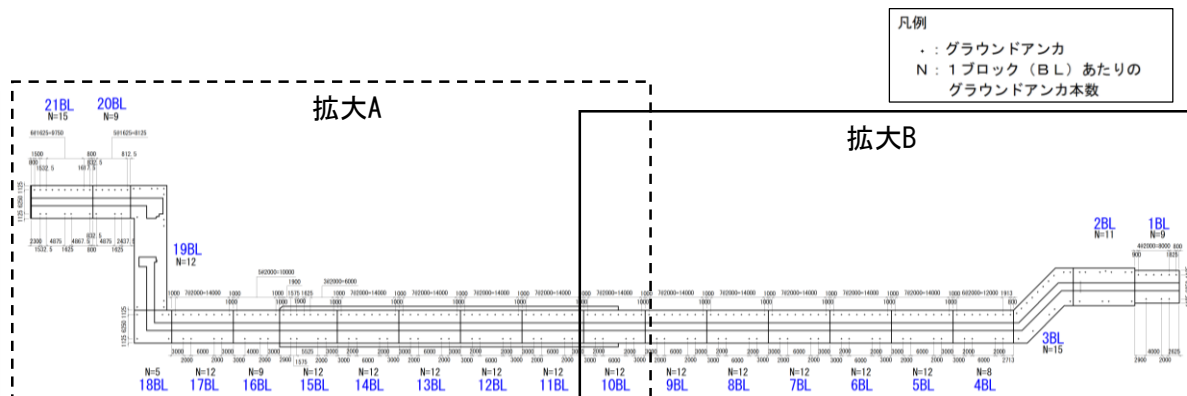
(1) 防波壁（逆T擁壁）のグラウンドアンカ配置図（全体平面図）
